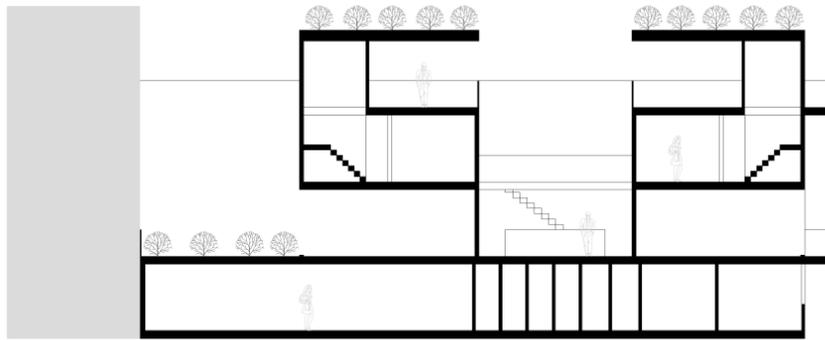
Corte a viviendas tipo dúplex y terrazas del segundo nivel
